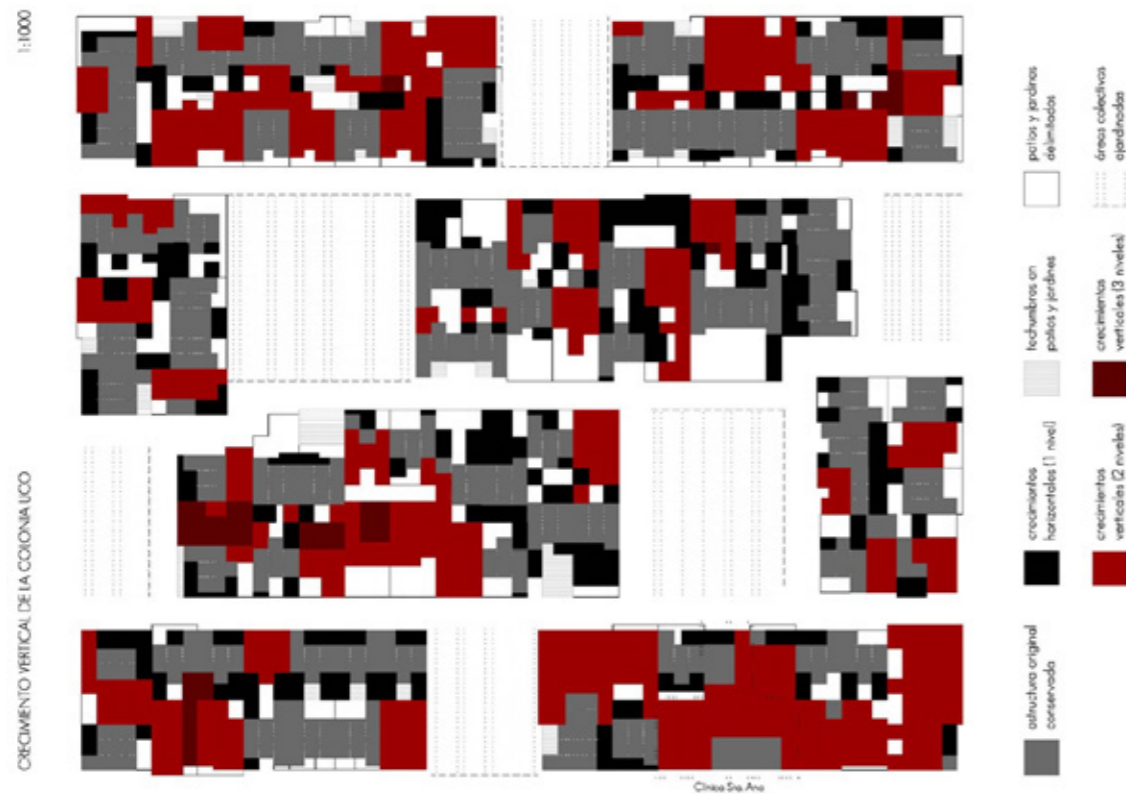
Esquema de estado actual de viviendas en sector septentrional. Elaboración propia
